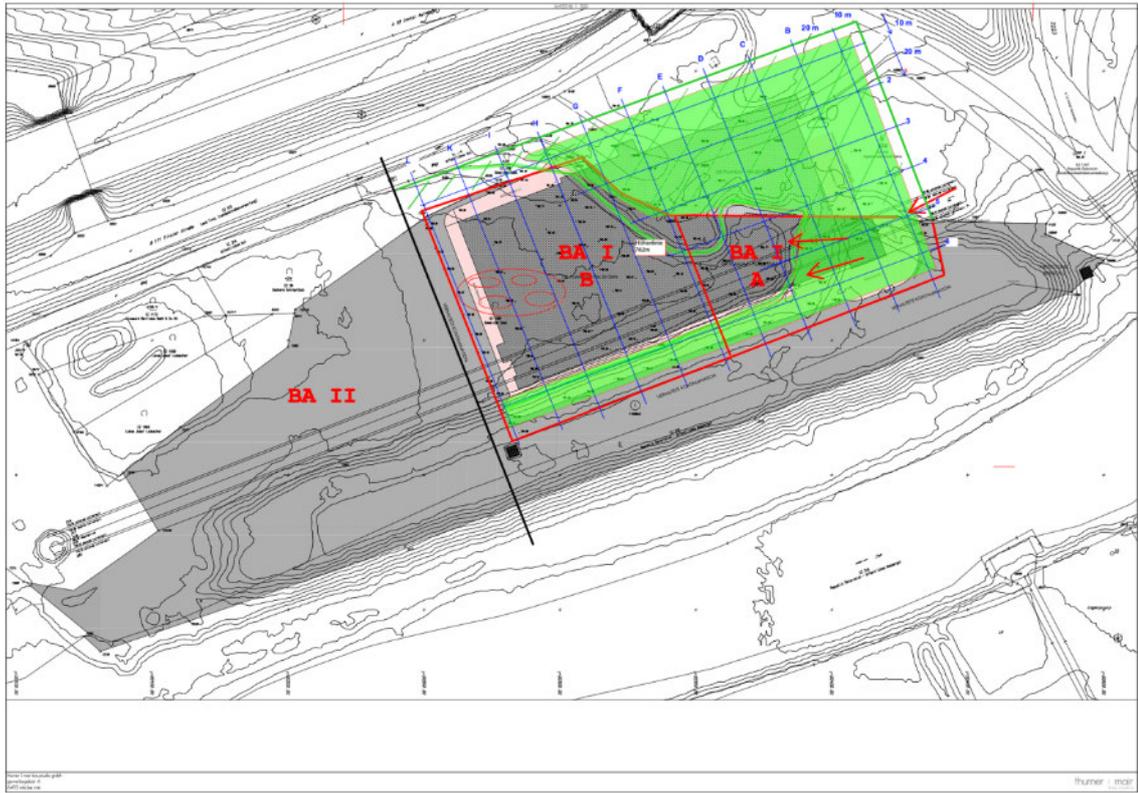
Plan mit Einteilung der Bereiche [Architekt: thurner | mair bau.studio]
